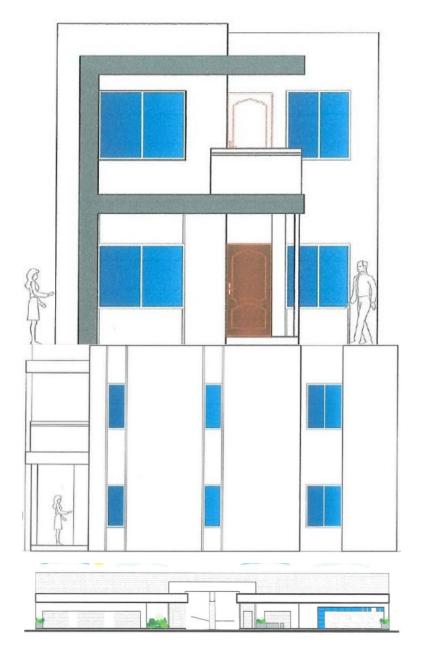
Fachadas del proyecto. Fuente: Imagen facilitada por el promotor del proyecto.
